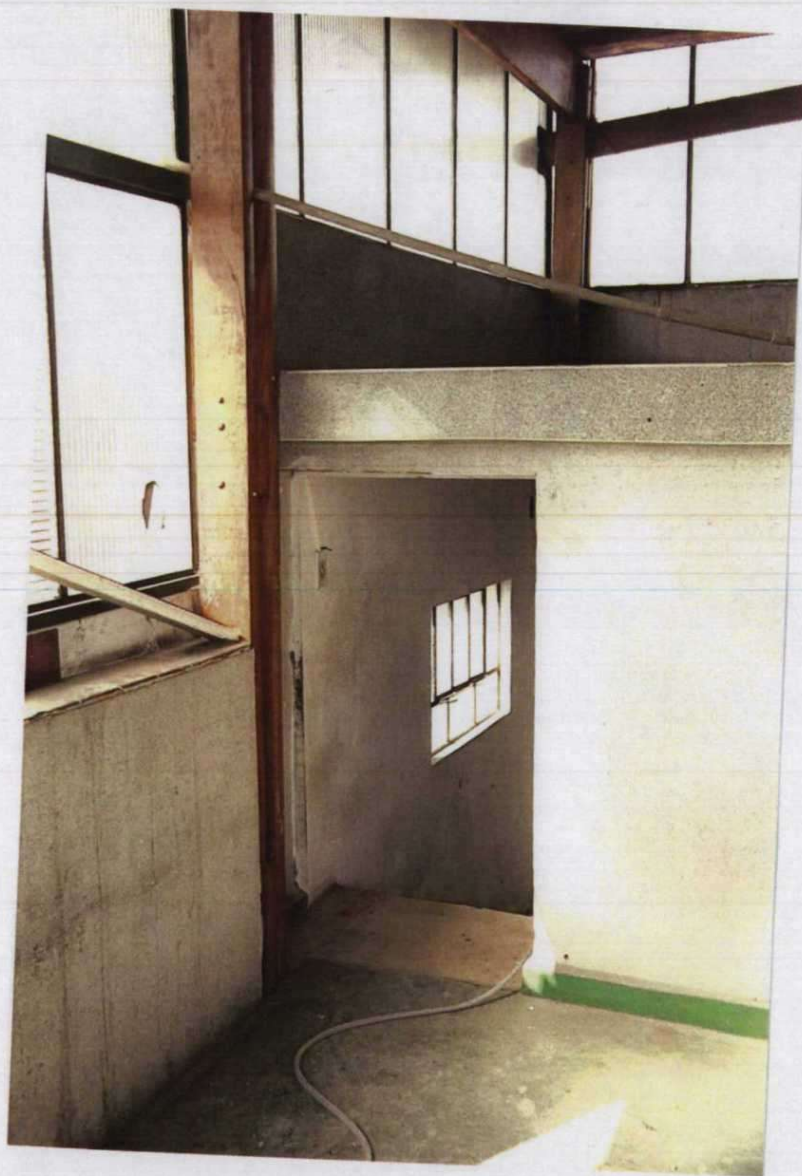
ACESSO A INSTALAÇÕES TÉCNICAS
